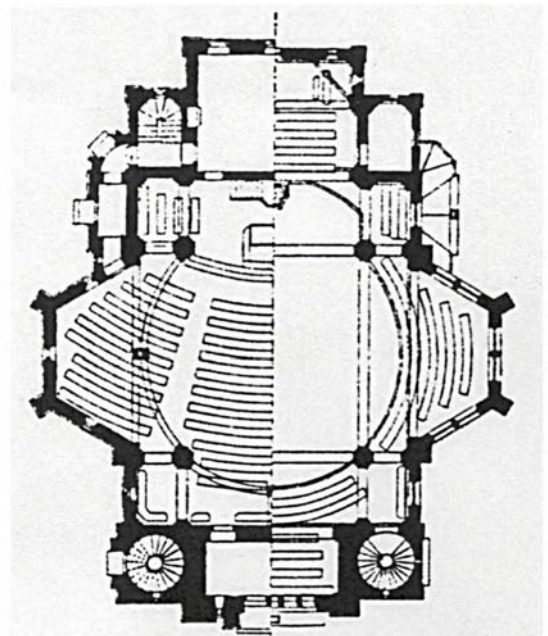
Grundriss Erd-/Emporengeschoss
